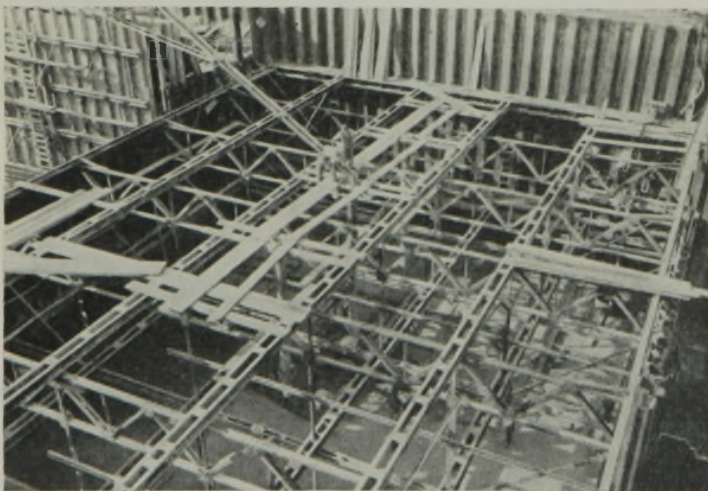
Oberhauptbaugrube mit Aussteifungskonstruktion.
